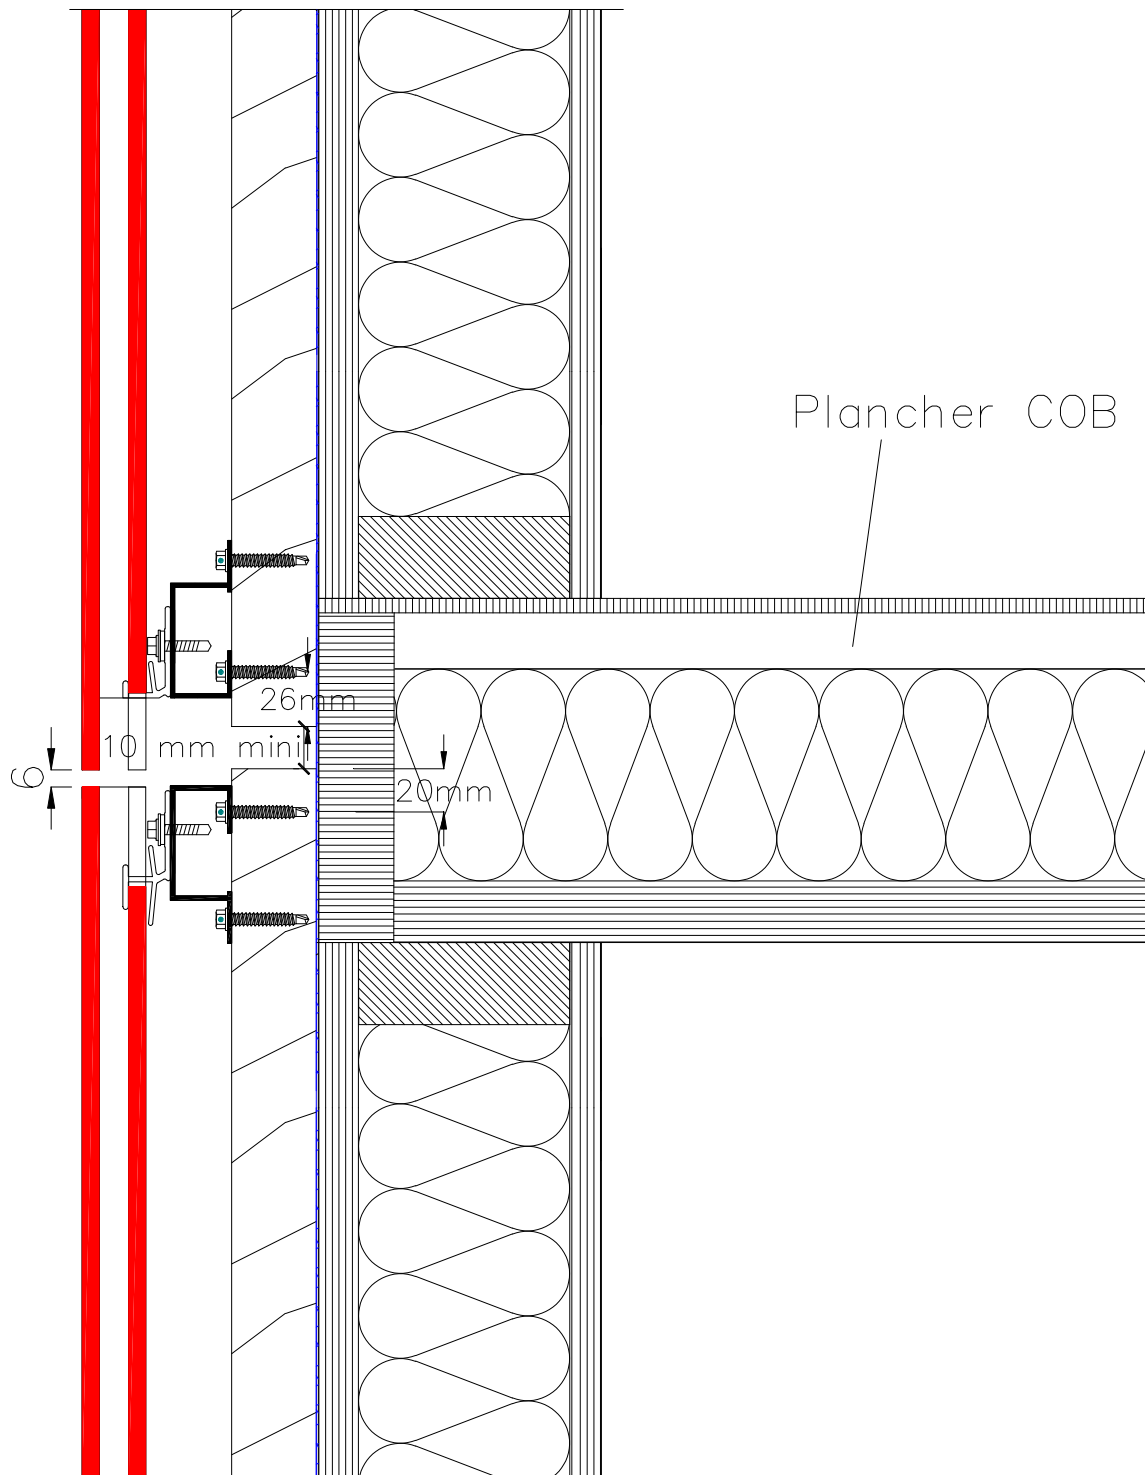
Fractionnement de l'ossature à joint ouvert au droit de chaque plancher sur COB/CLT
